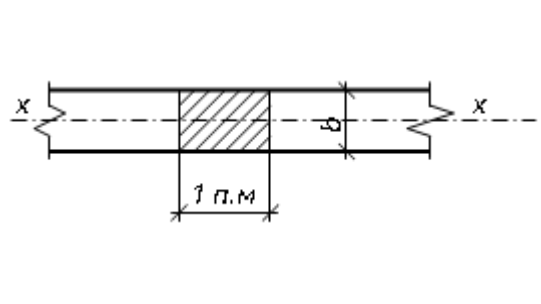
Схема до перевірки напруження під подошвою позацентрово навантаженого фундаменту
